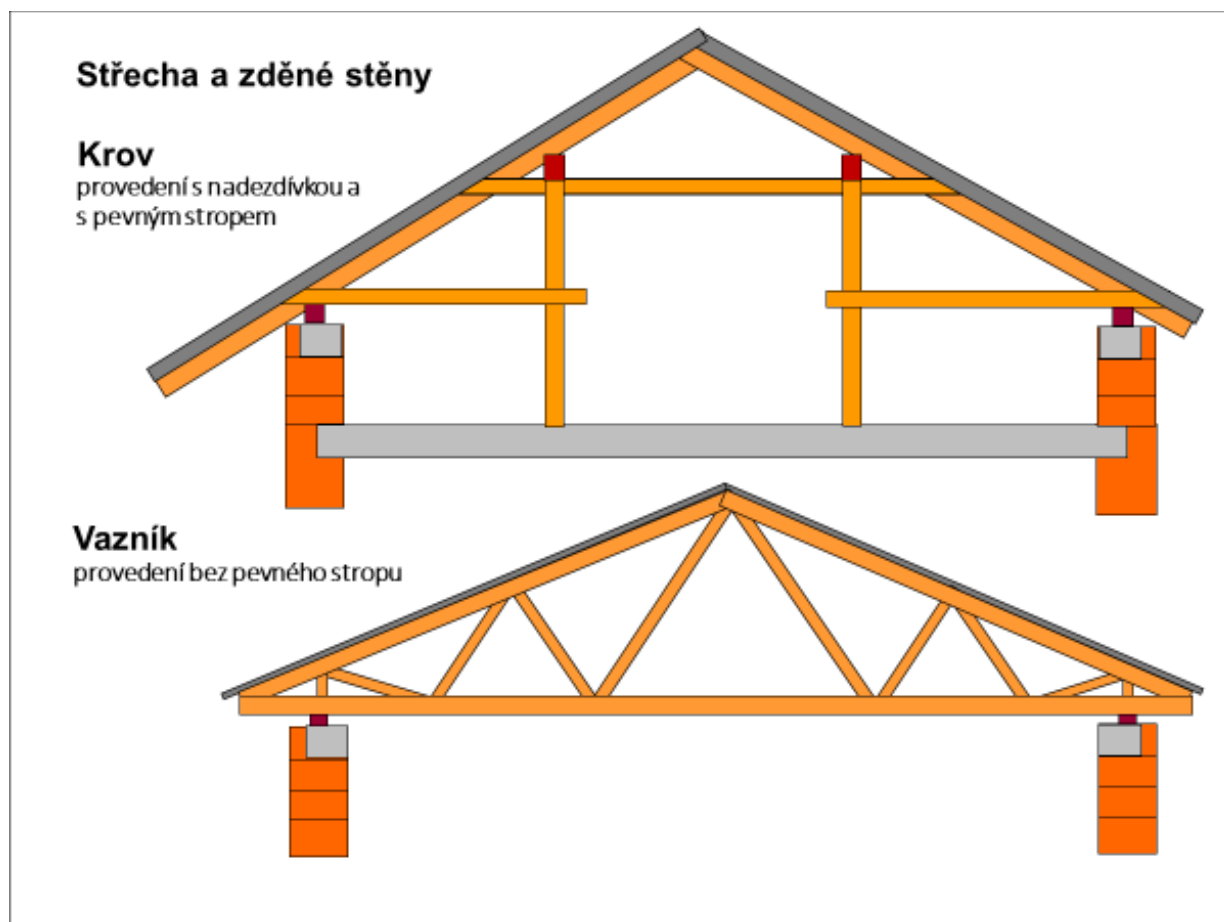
Sklonité střechy - základní typy konstrukce s působením na zdivo
